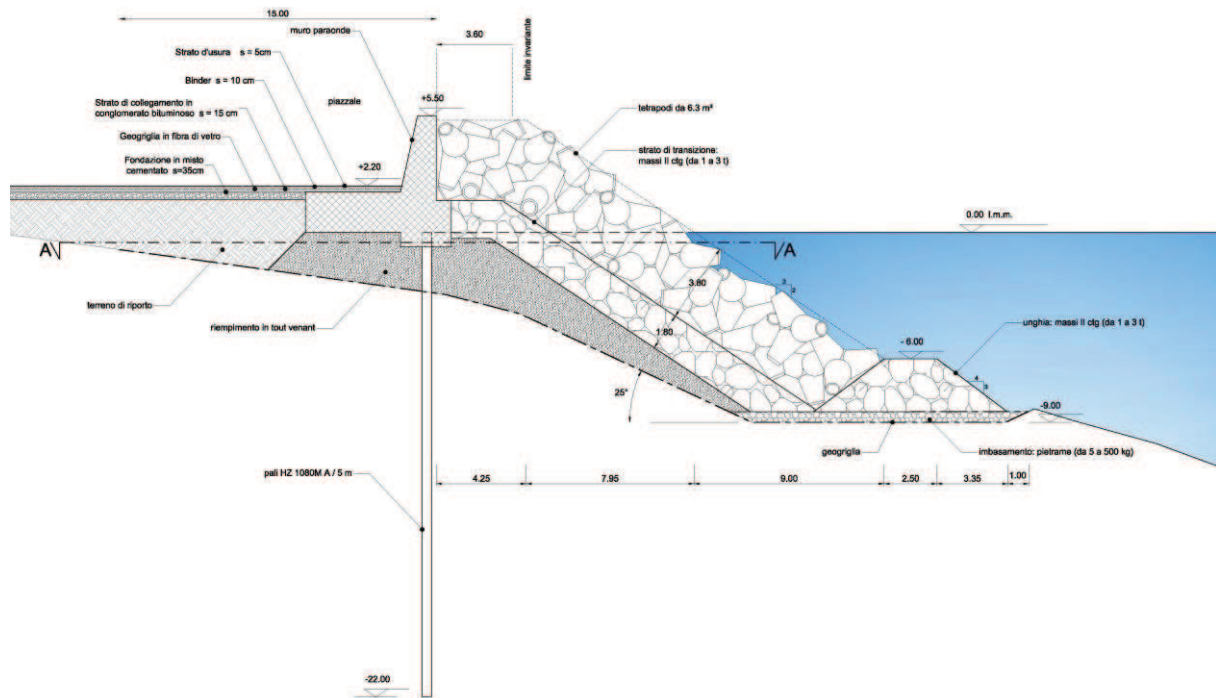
Sezione tipo scogliera lato sud (PROGETTO SIGENCO).
